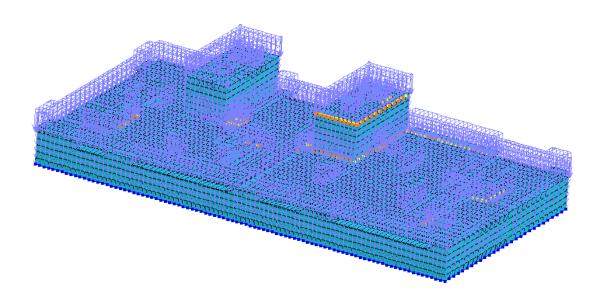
Расчетная схема плиты покрытия с нагрузкой от собственного веса элементов железобетонных конструкций
